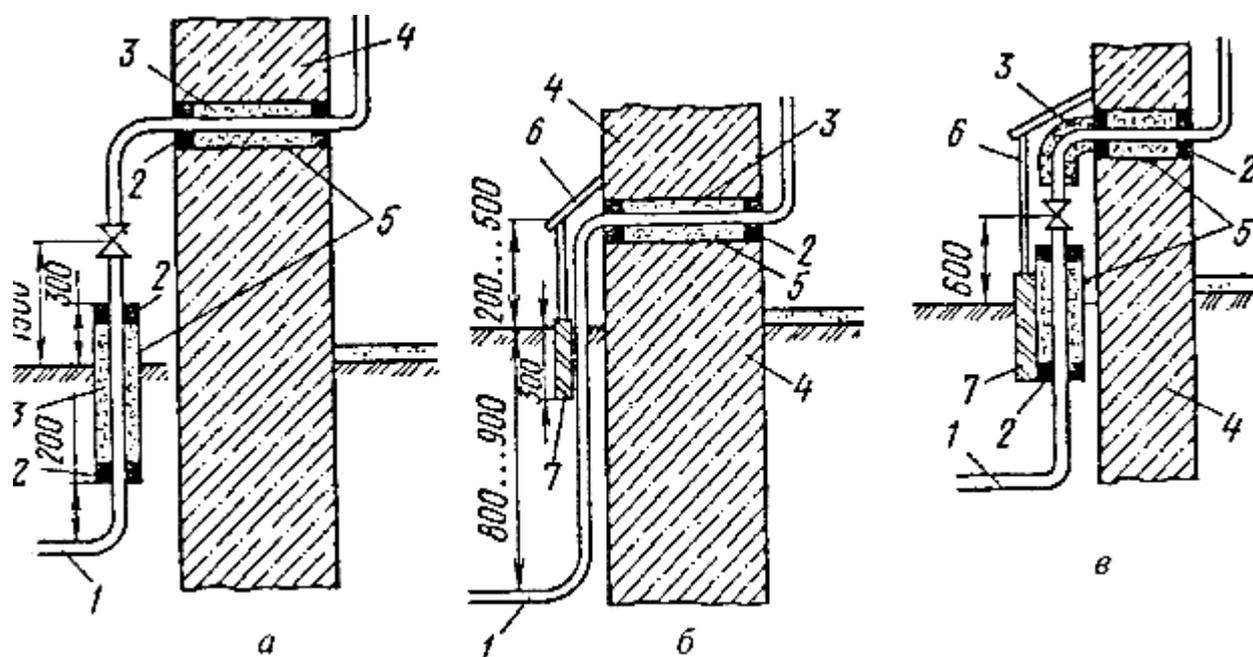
Вводы в здание: а - осушенного газа, б, в - влажного (сжиженного) газа; 1 - трубопровод; 2- битум, 3 - теплоизоляция, 4 - стена, 5 - футляр, 6 - шкаф, 7- кирпичная кладка
